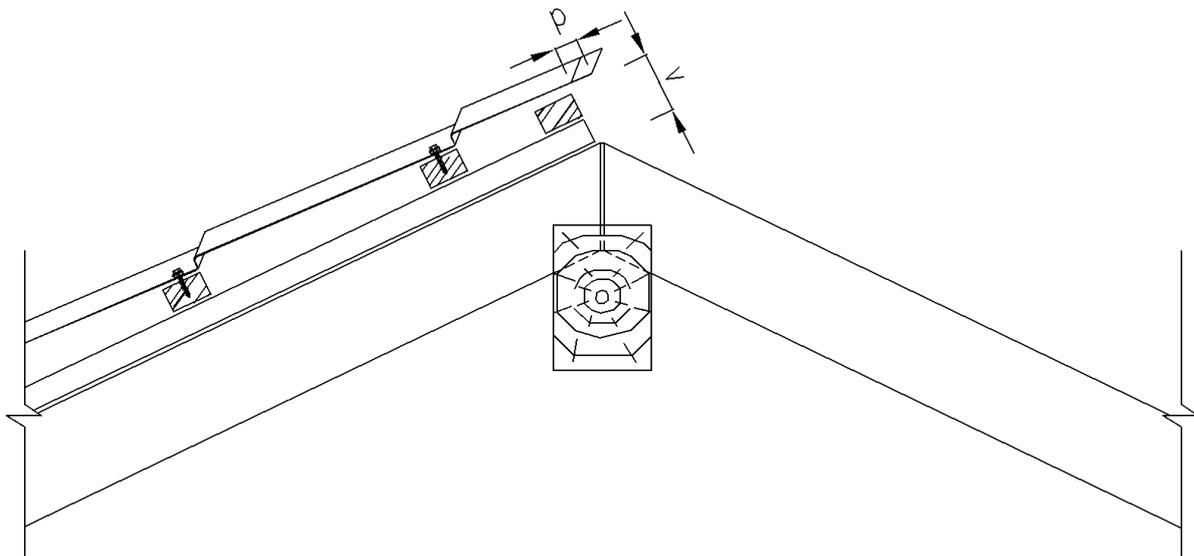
Ergänzung der Dachdeckung ggü. der Länge der Sparren beim Dachfirst
